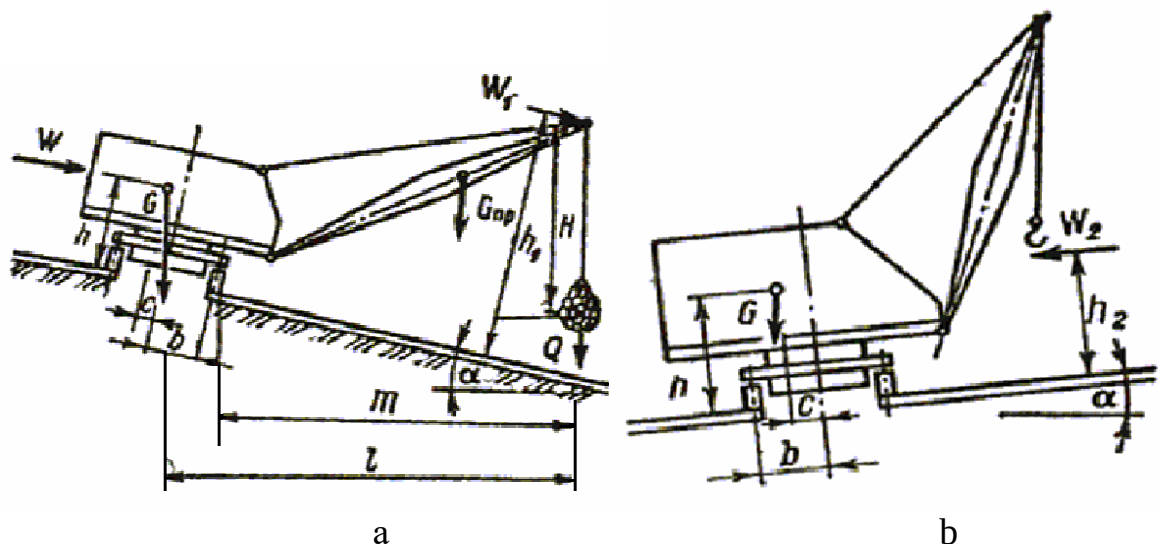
Схема устойчивости крана а – грузовая устойчивость б – собственная устойчивость
